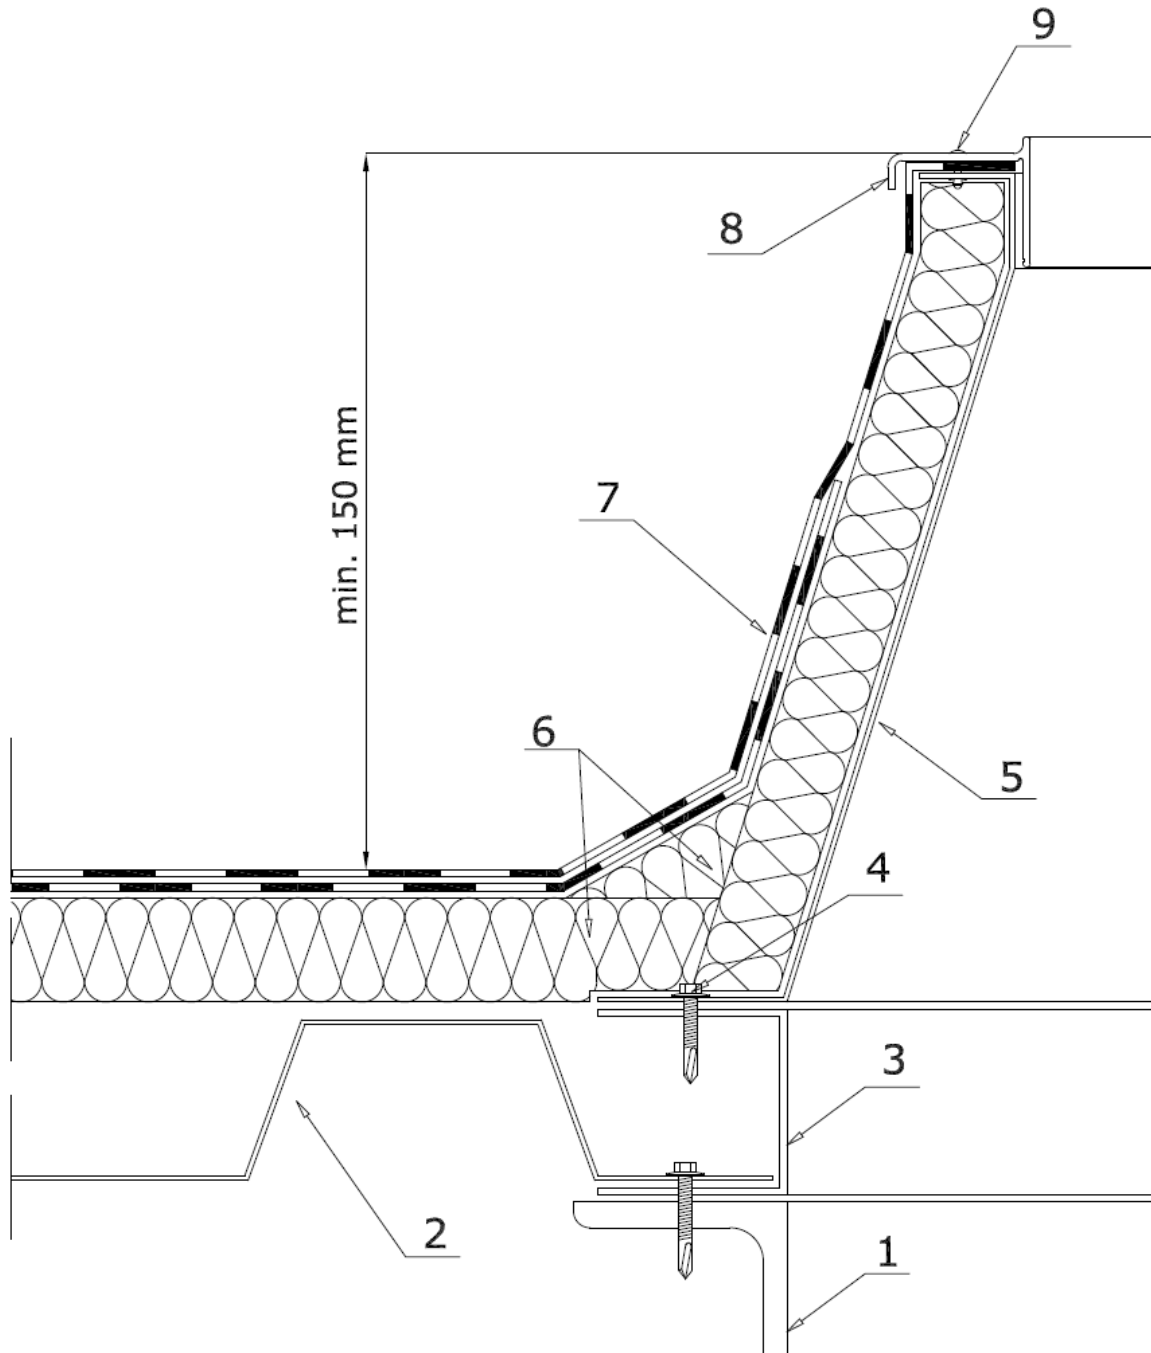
Sposób połączeń podstawowych elementów wylazu dachowego (podstawa z laminatu)
